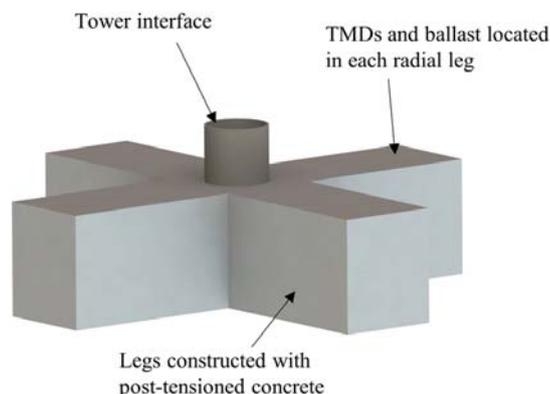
Конструкция фундамента с крестообразной формой подошвы
